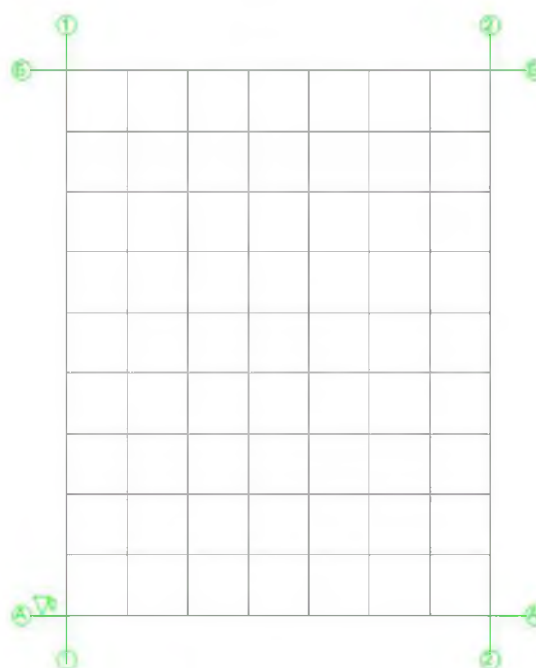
Расчетная схема монолитного перекрытия
